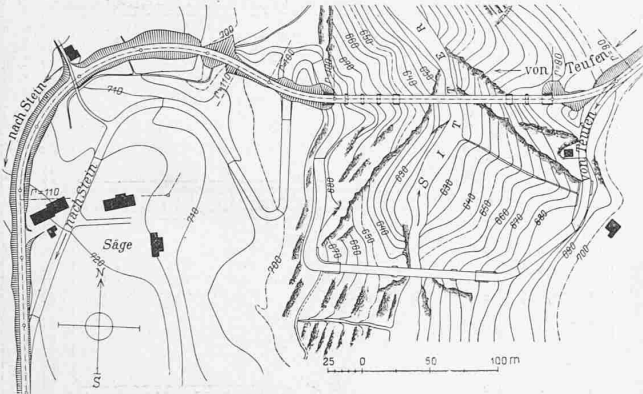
Lageplan mit der alten und der neuen Brücke. — 1 : 5000.
